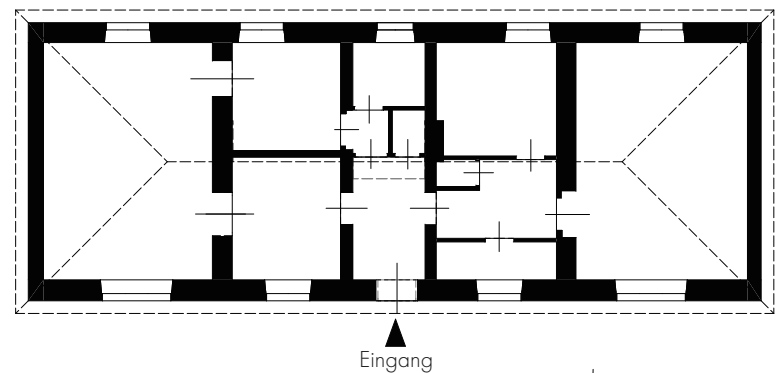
Bestandsplan Albertihaus, Grundriss Erdgeschoß
